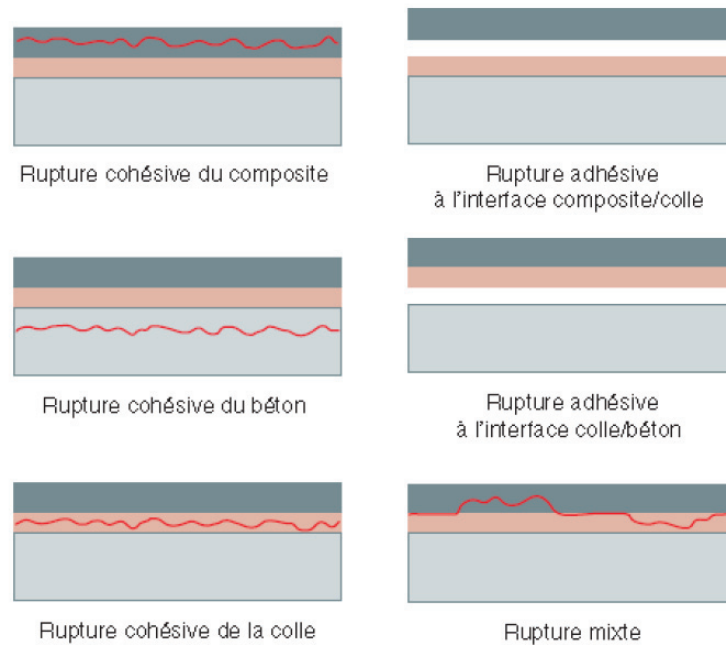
Modes de rupture d'un joint de colle, composite et béton [Chataigner 2010]
